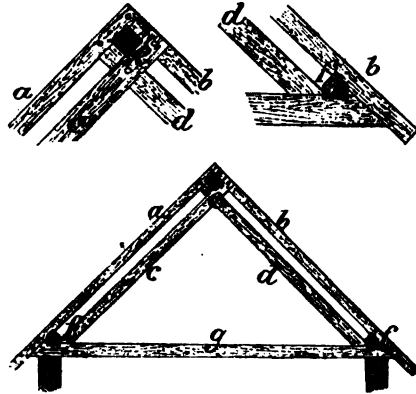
Querschnitt eines Pfettendaches, a b Dachsparren, c d Hauptsparren, e Sparrenschwellen, f Pfette, g Bundbalcken.
